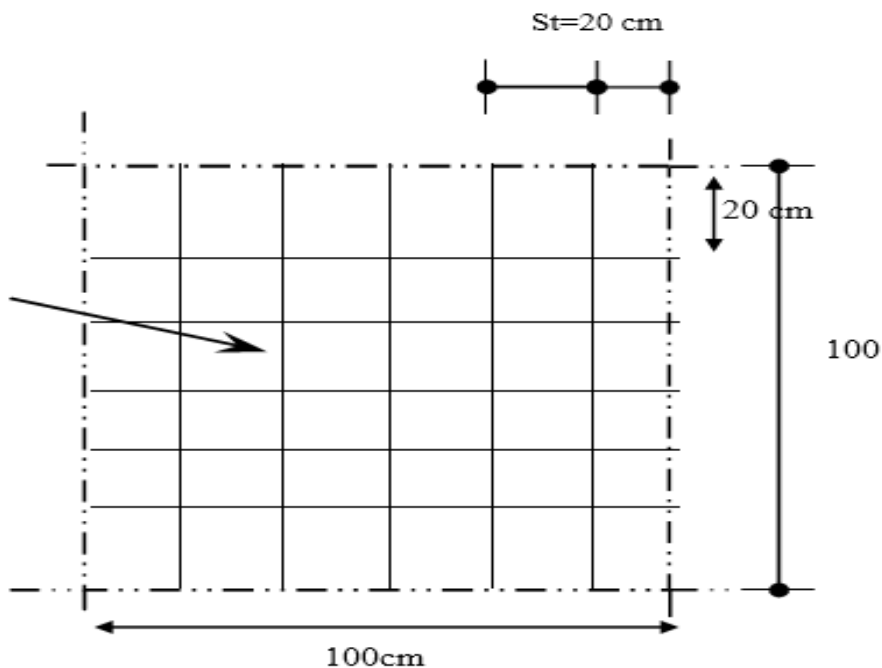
Disposition constructive des armatures de la dalle de compression
